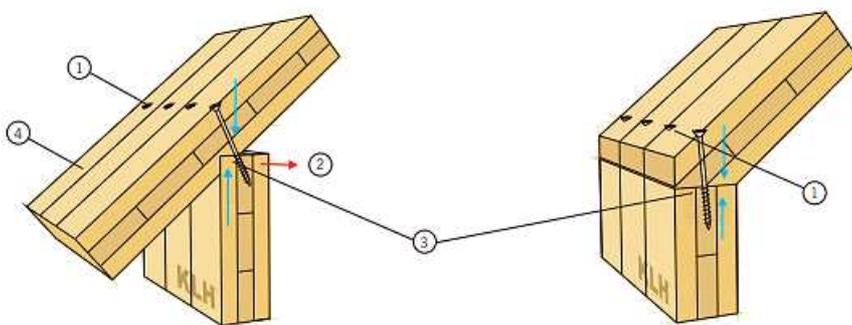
Ligação entre painéis de laje (parafusos roscados) [24]
